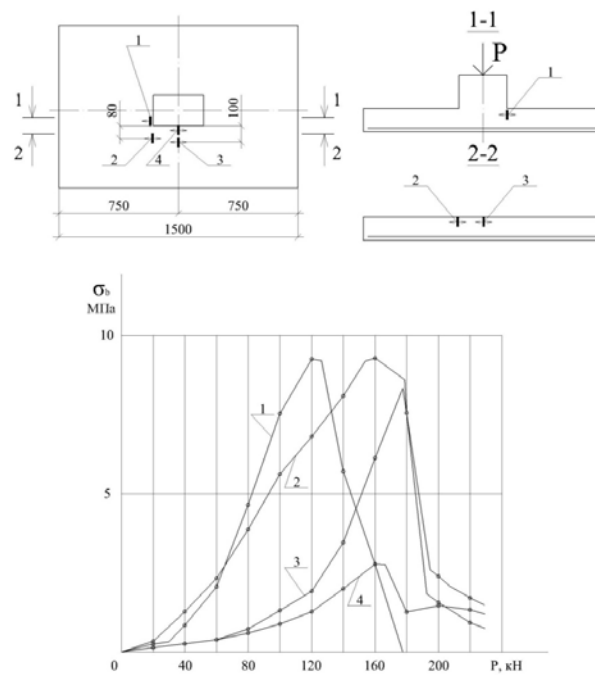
Зависимость напряжений в сжатой зоне бетона плиты фундамента Ф-3-2 от уровня внешней нагрузки
